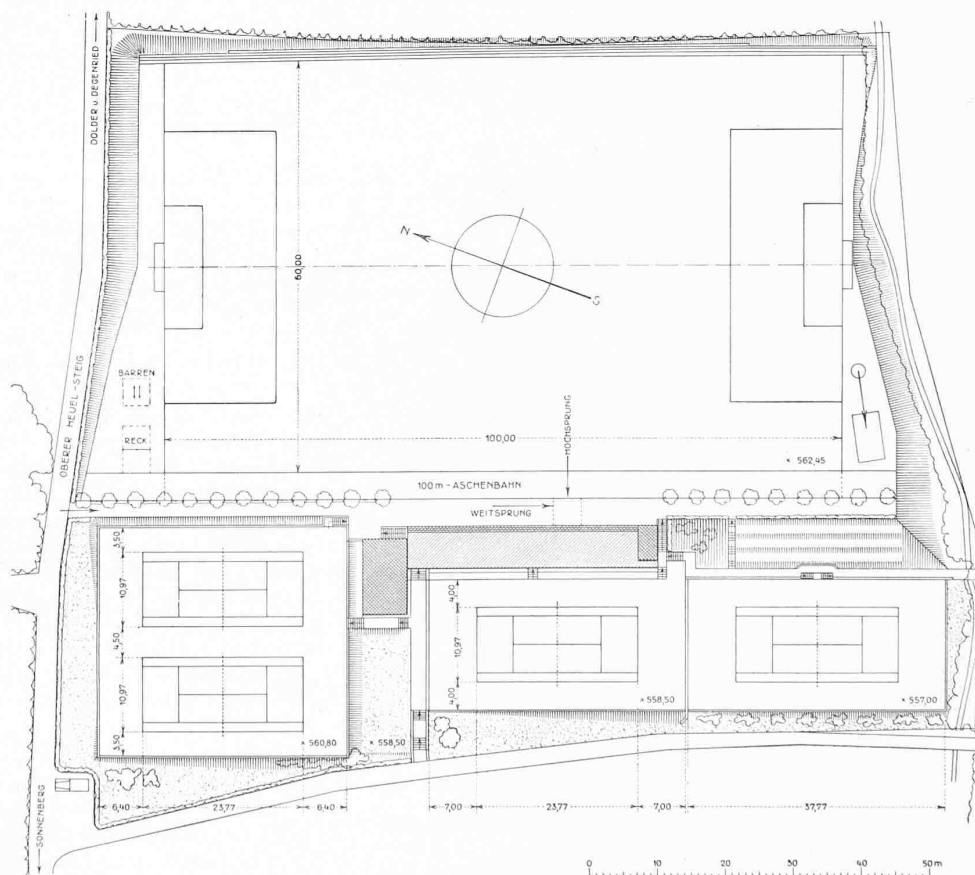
Sportplatzanlage Sonnenberg, Zürich. — Lageplan, Masstab 1 : 1000.
